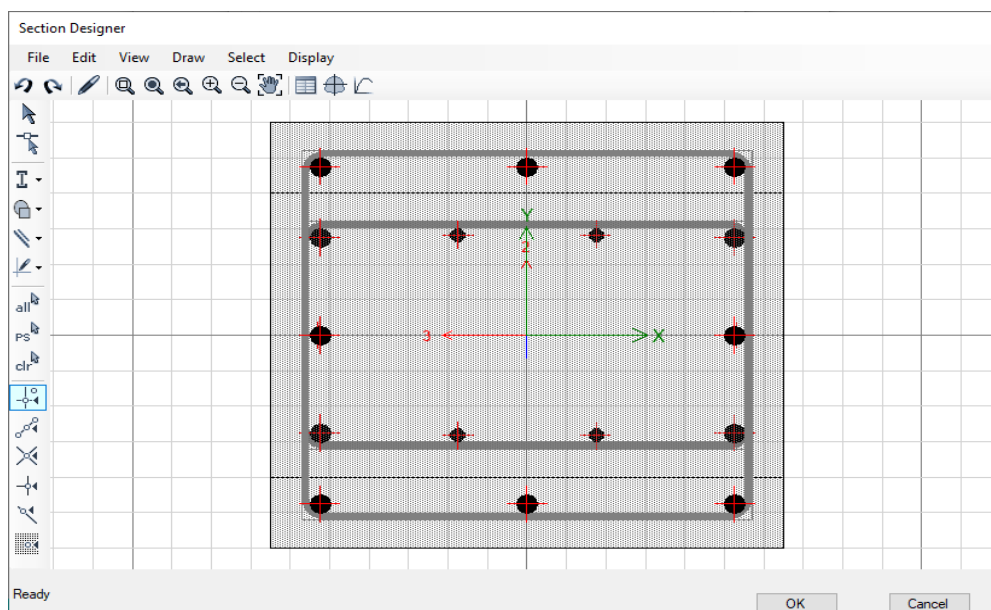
Sección de columna reforzada 60 cm x 65 cm
